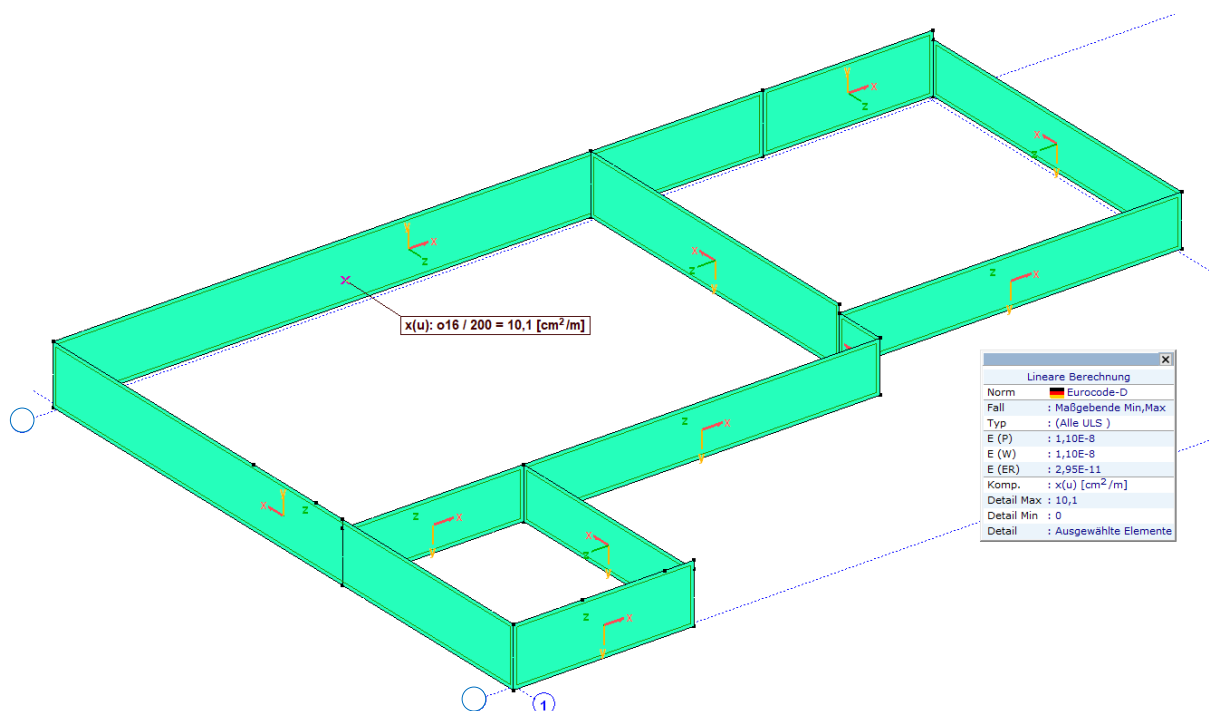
Entworfenere Bewehrung außen in lokaler x-Richtung (horizontal)
